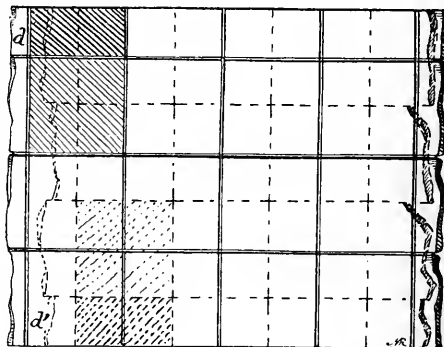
Plan de l'appareillage d'un mur de trois carreaux et demi d'épaisseur.
